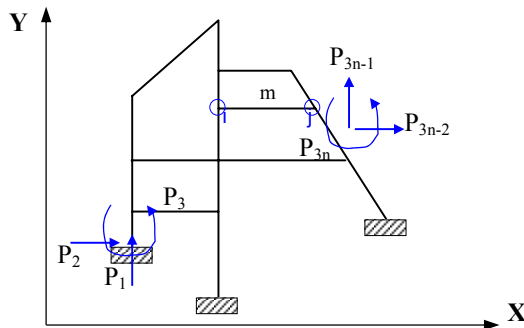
Sistema apórticado plano con fuerzas externas.
